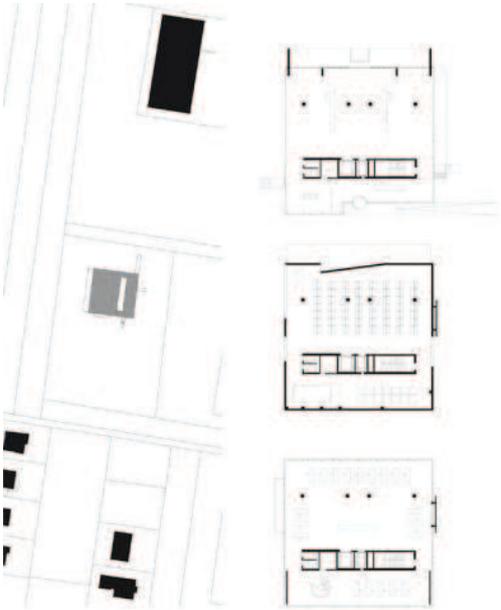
Lageplan, Schnitte, Grundrisse
